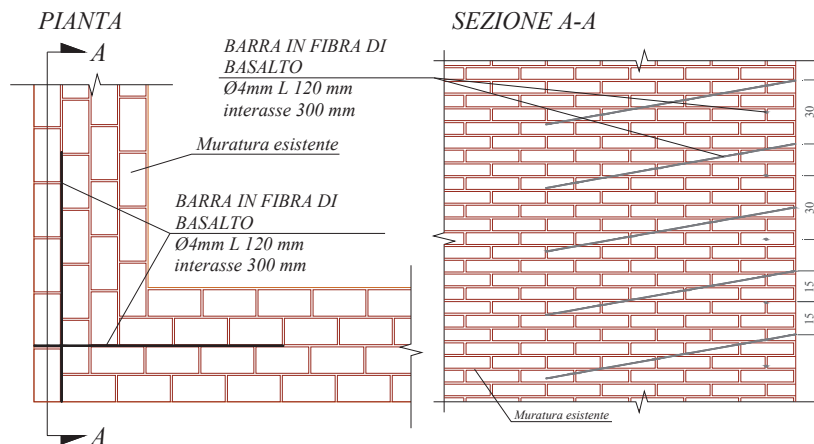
Schema dell'intervento di repointing armato sulle angolate con barre inclinate in fibra di basalto.
